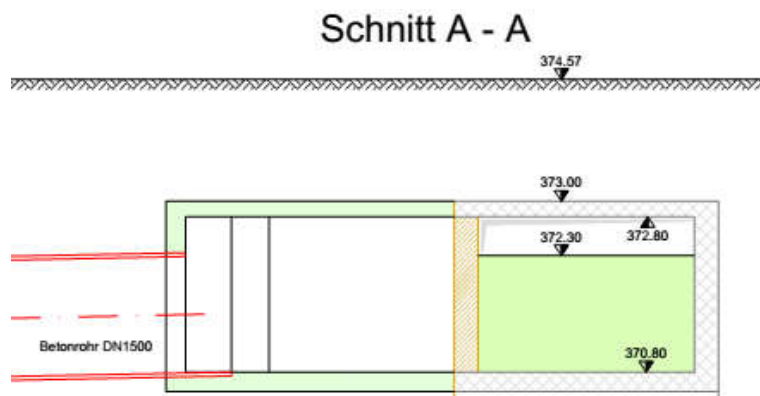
Auszug Plan 104 Abnahmebauwerk
